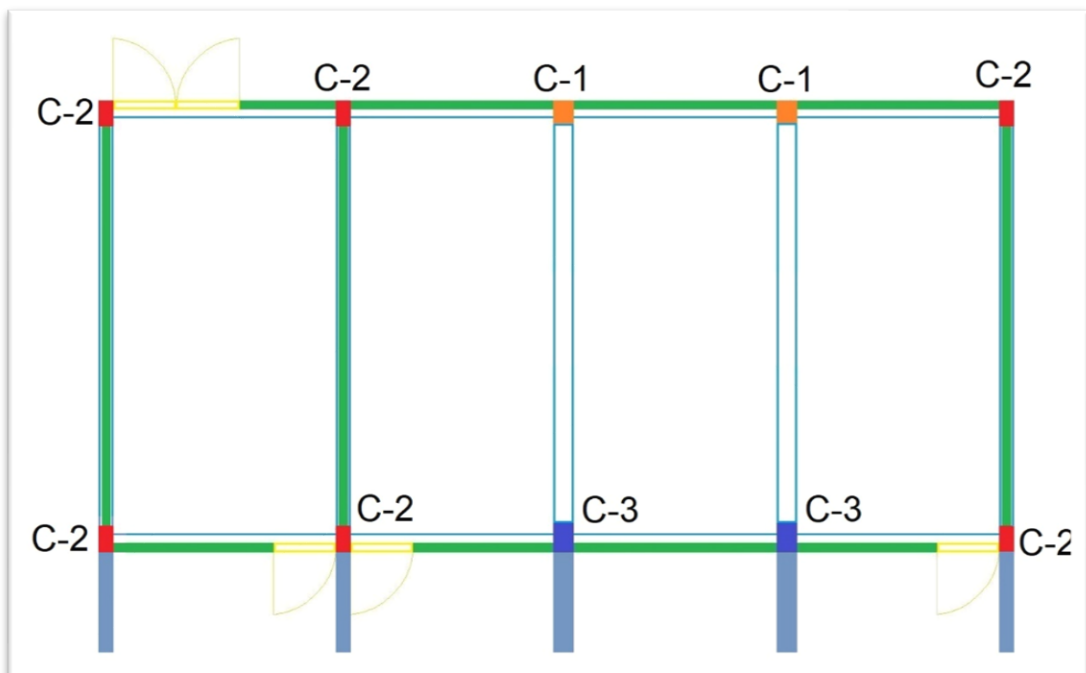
Distribución de columnas del pabellón 11 – bloque B.
